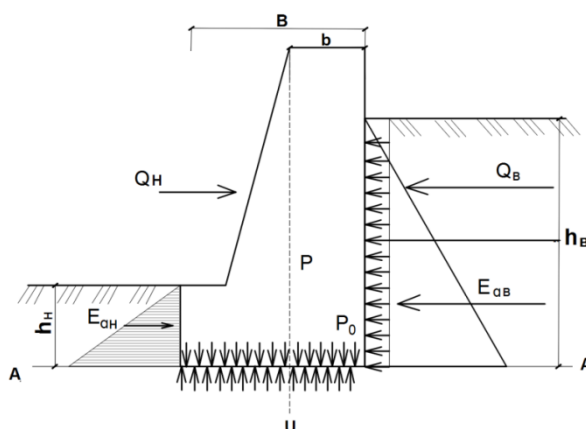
Схема к расчету коэффициента запаса устойчивости сооружения, воспринимающего горизонтальную нагрузку, на сдвиг по подошве фундамента
